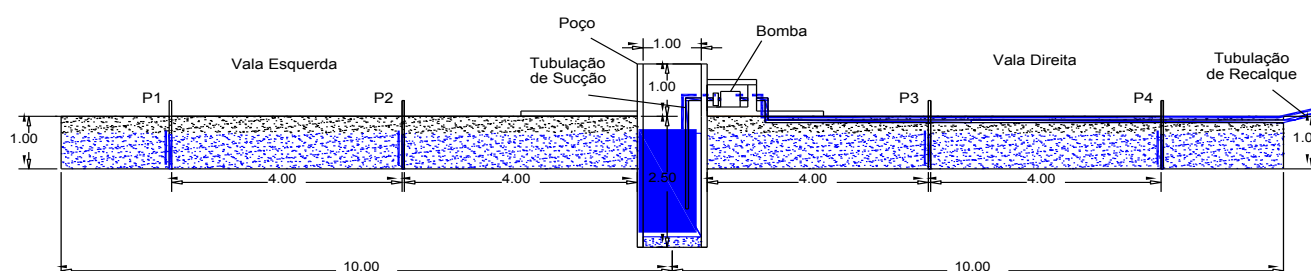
Corte Paralelo a Barragem do Projeto executado no reservatório de Mundaú
